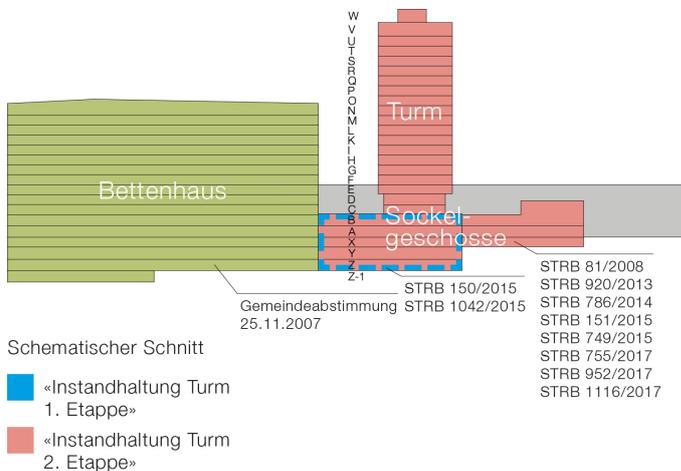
Abgrenzung der Etappen Instandhaltung Turm gemäss STRB Nr. 150/2015 und STRB Nr. 151/2015. Geschossbezeichnungen Neubau Bettenhaus und Turm (ehemals Hauptgebäude)
